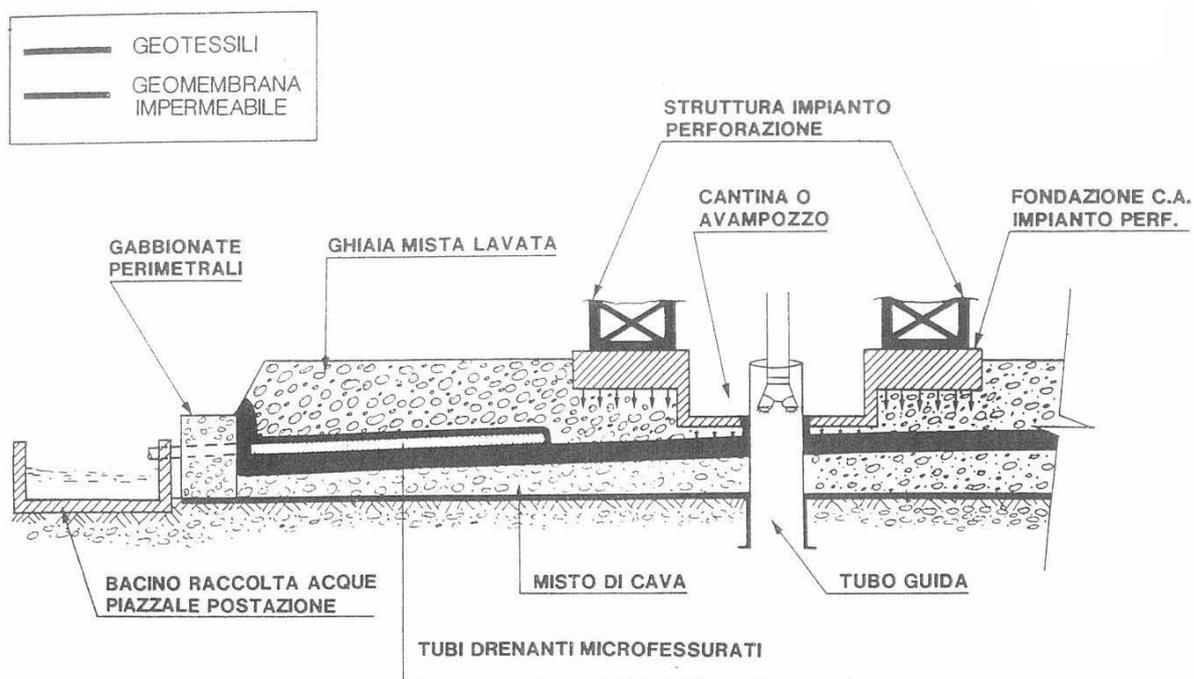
Schematizzazione impermeabilizzazione e sistema drenante di una piazzola di sonda
